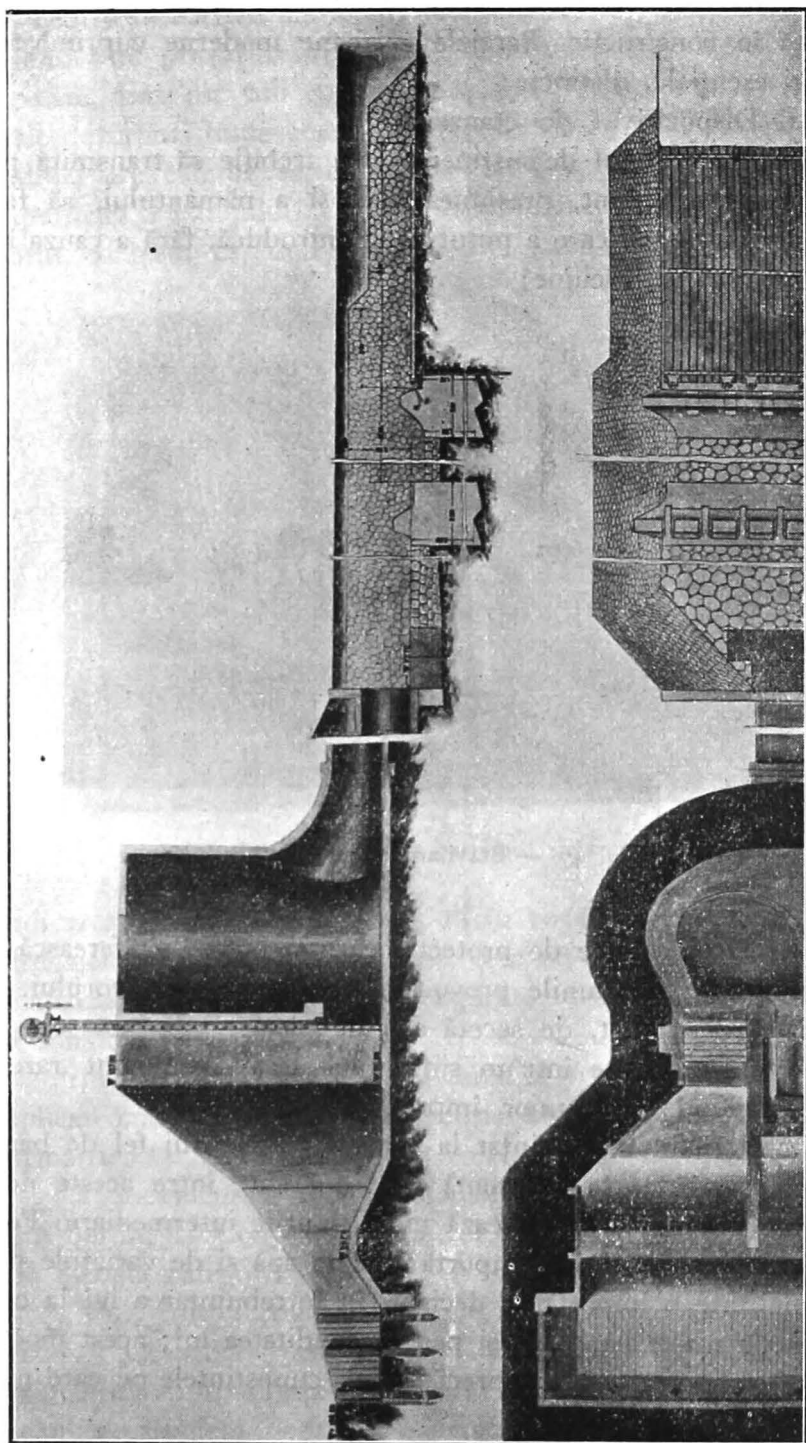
Proiectul stăvilarelor la barajul lacului Buftea.
